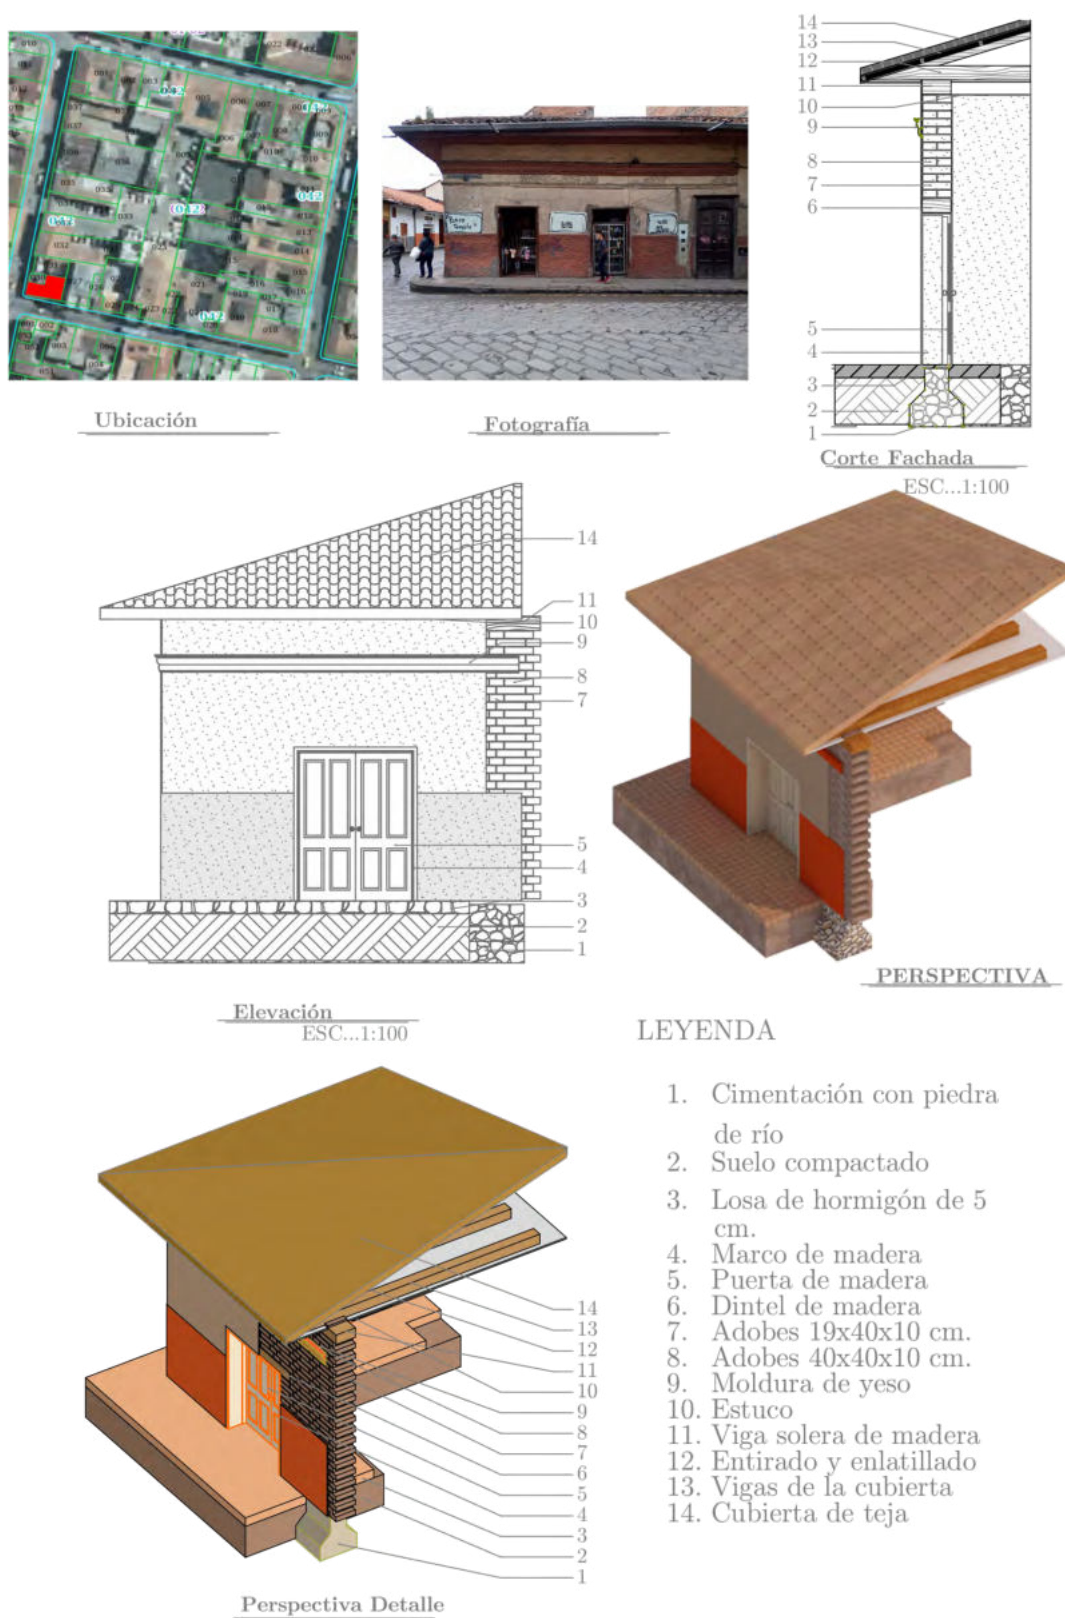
Sistema constructivo de un muro de adobe
